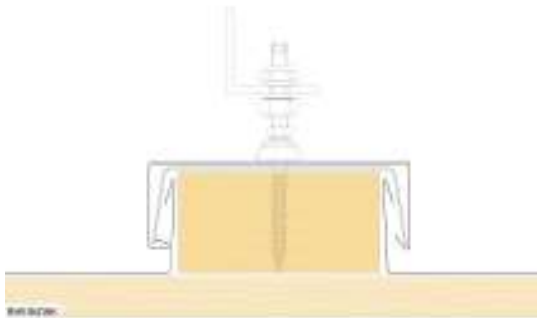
Befestigungsmöglichkeit mit Holzleiste und dichte Stockschraube als Solarbefestiger
